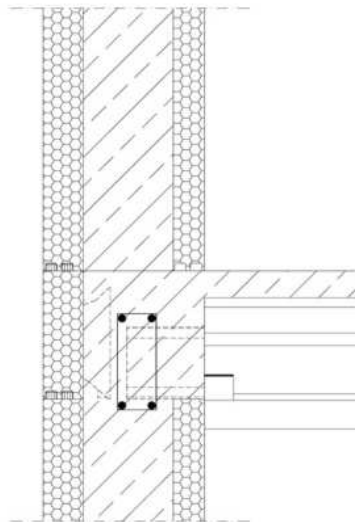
Armadura perimetral (corte vertical) (ARGISOL, 2010).
